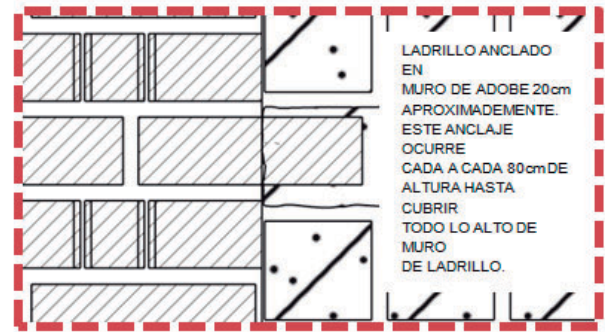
Detalle 2D de la unión de muro de ladrillo con un muro de adobe.
